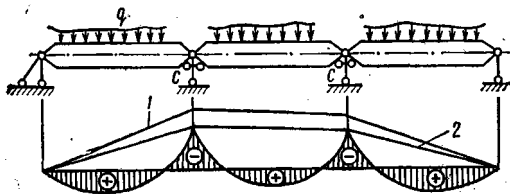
Эпюра изгибающих моментов от внешней нагрузки в железобетонной балке, собранной из отдельных элементов (заштрихована)
